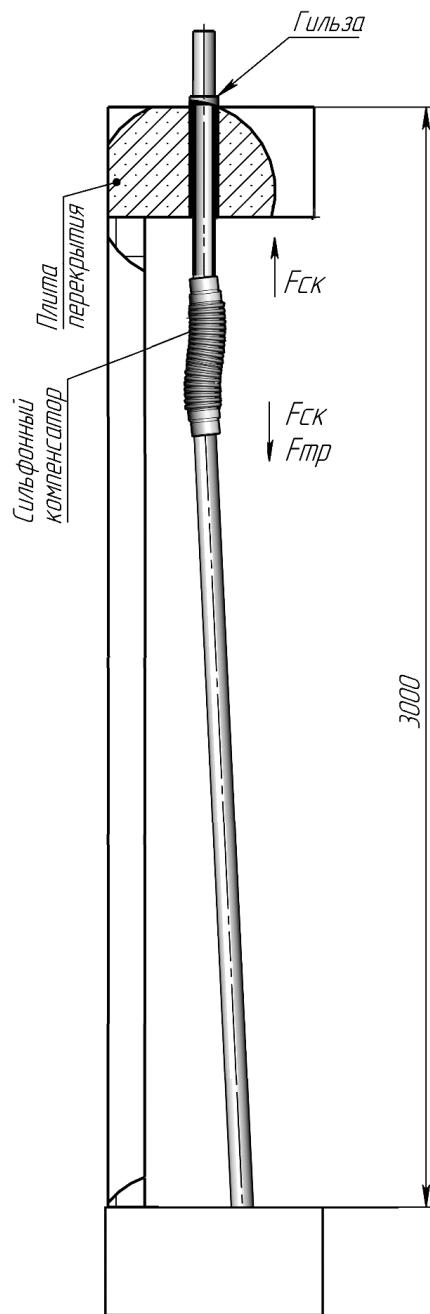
Расчётная схема установки сильфонного компенсатора без подвижных опор и без распределения нагрузки от компенсатора и веса трубы.
